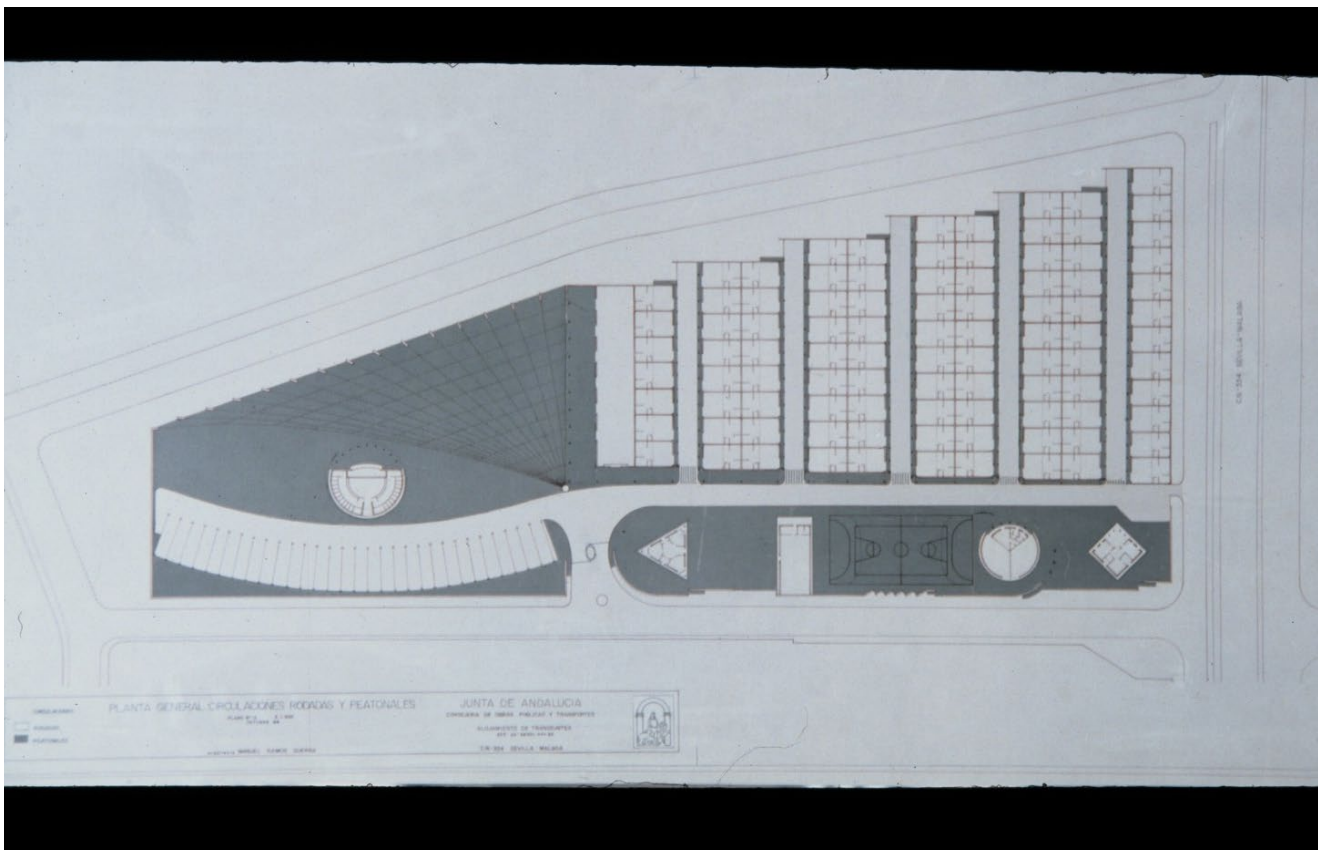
Planta general del proyecto de Alojamiento para Transeúntes del arquitecto Manuel Ramos Guerra en 1985.
